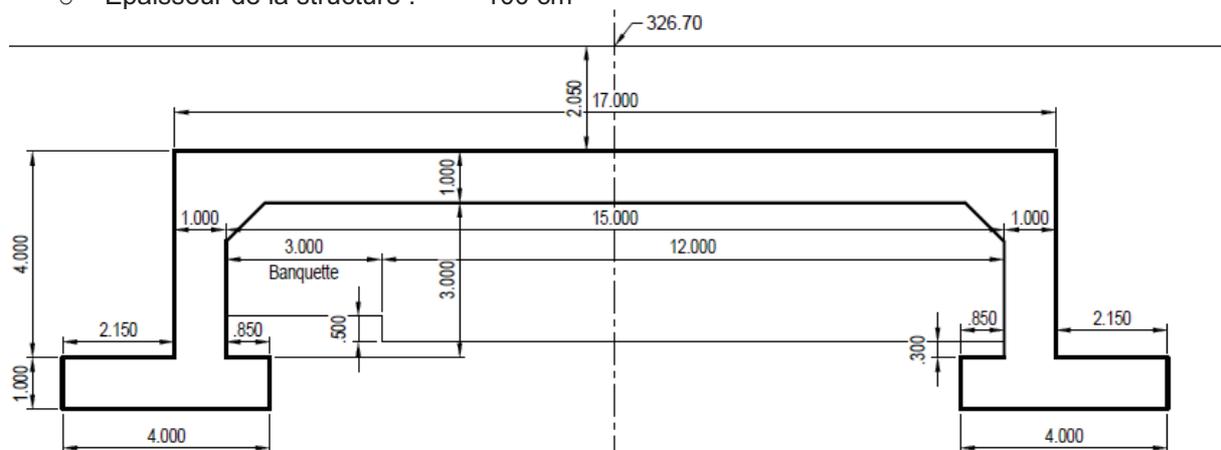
Coupe transversale de l'ouvrage projeté variante 2
